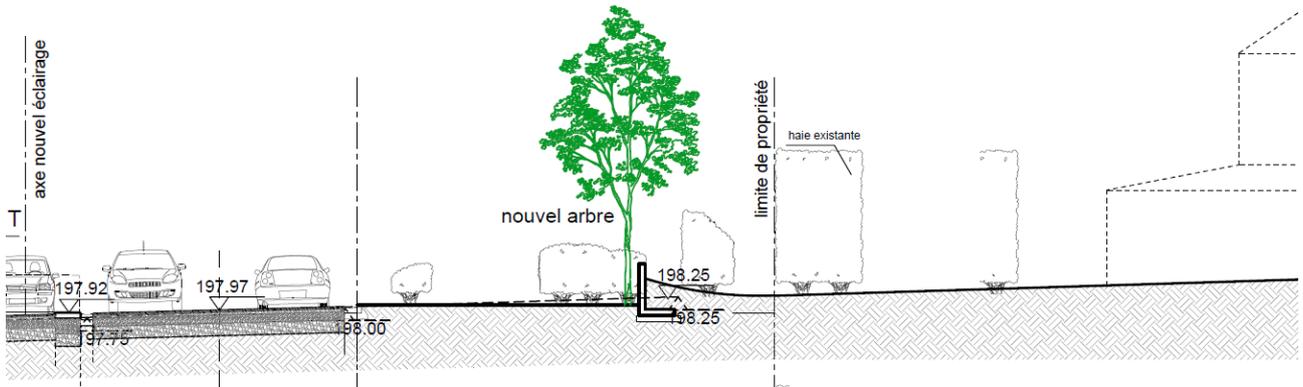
Illustration schématique du mur de soutènement mis en place le long du N°612A de la rue Gaillarmont (source : 6nergypark, 2023)
